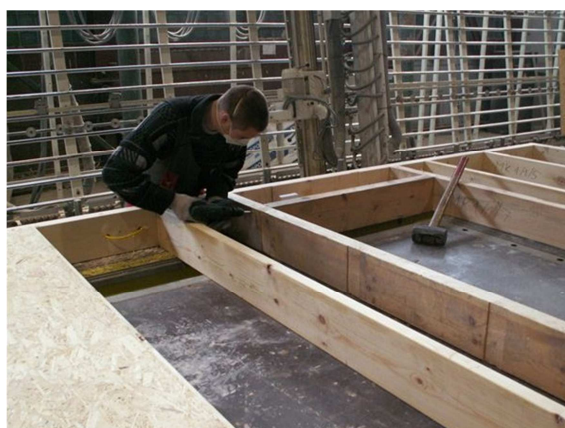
Construção de padieira de uma porta (<http://frame-house.eu>)
